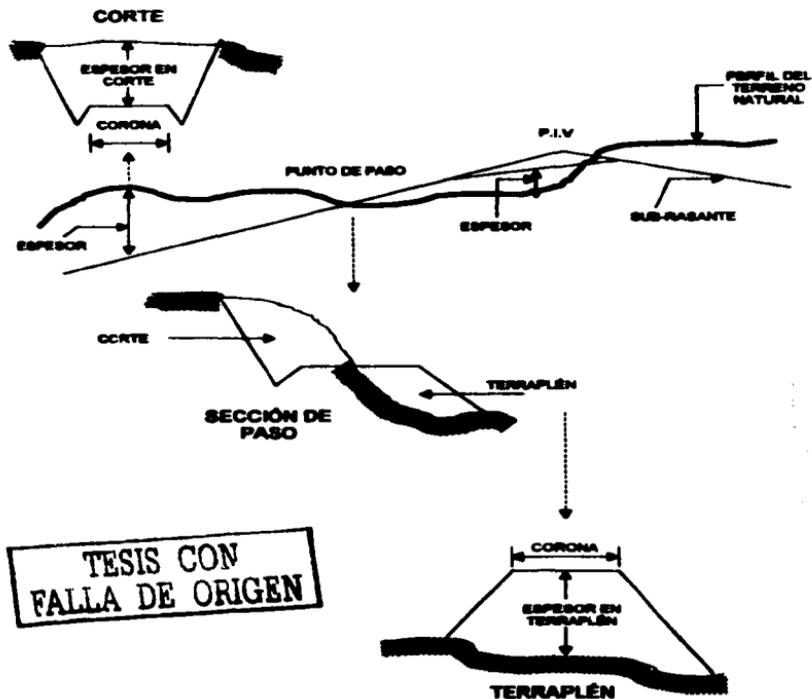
"Secciones de corte y terraplén para un pavimento"
